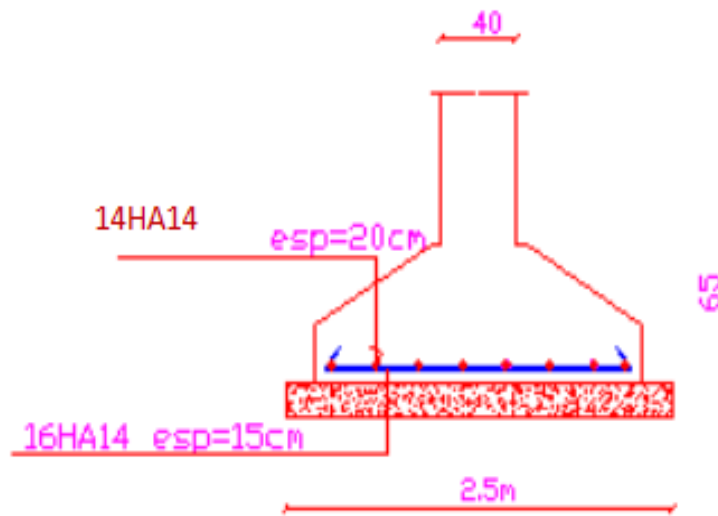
schéma de ferrailage de la semelle filante selon x-x
